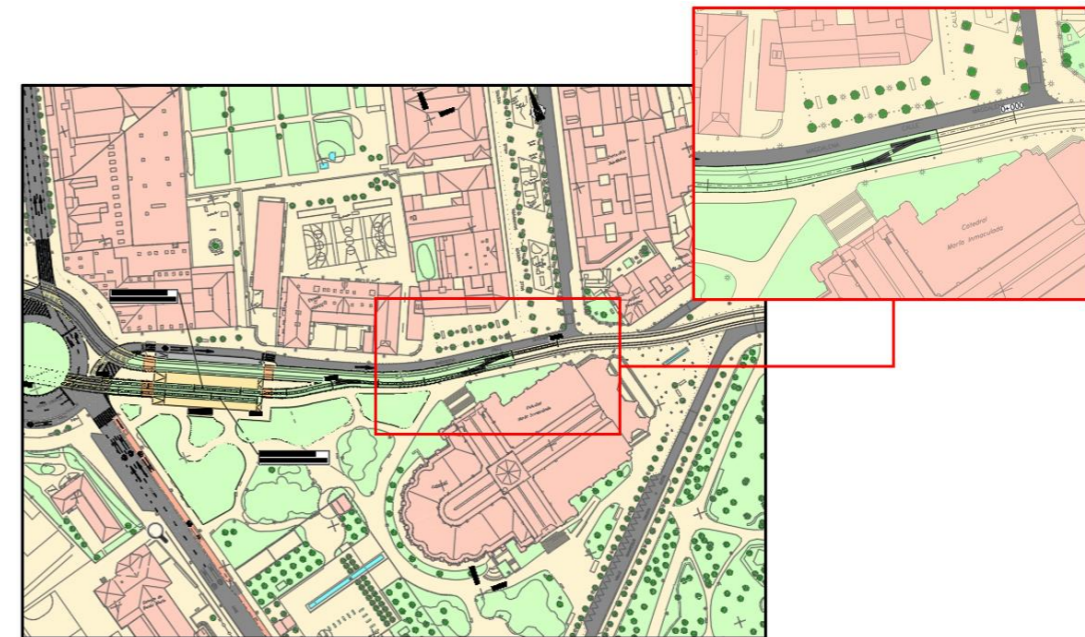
Afección a la línea existente: tramo Parlamento - Lovaina
